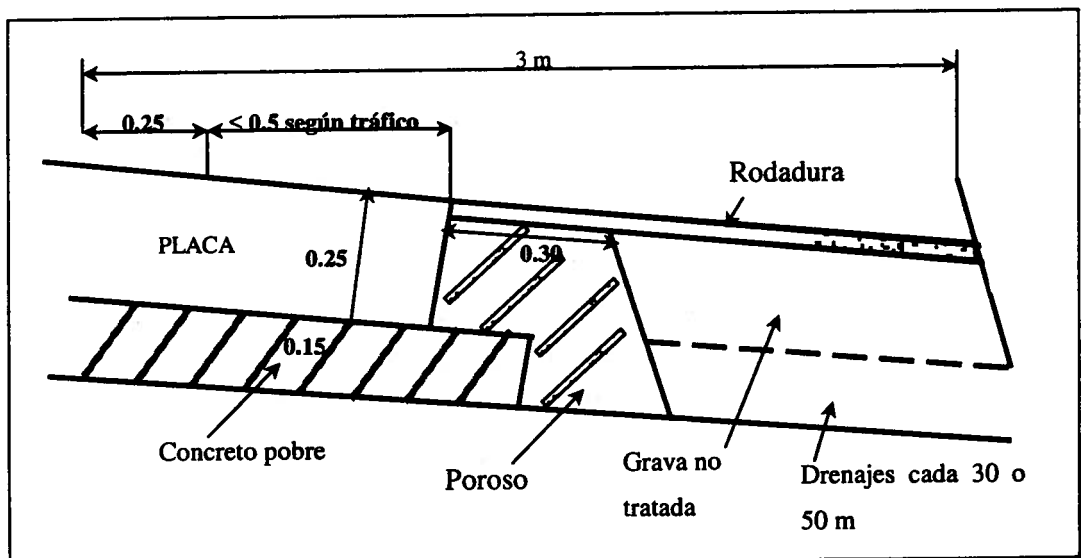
Ejemplo de la berma con drenaje lateral.
